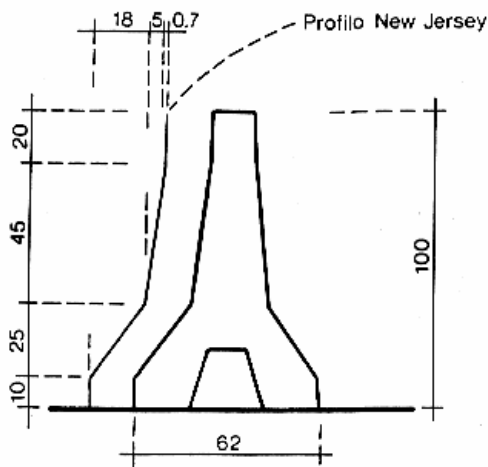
Barriera in calcestruzzo monofilare provvisoria per spartitraffico.
